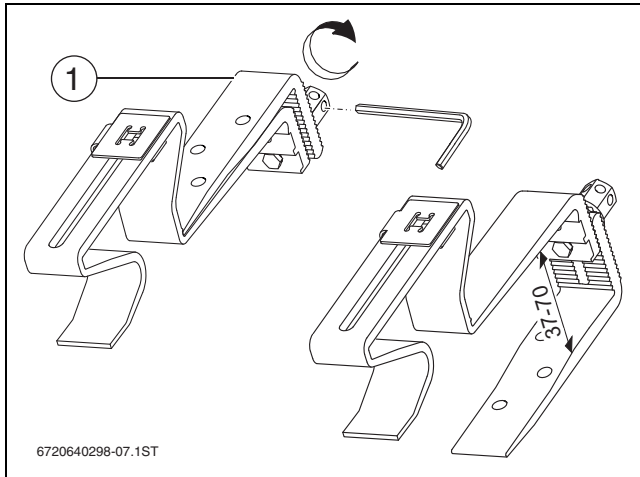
Dachhaken-Unterteil drehen, Maße in mm
